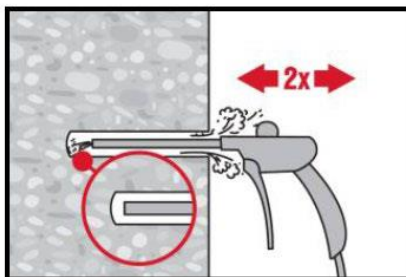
Схема очистки отверстия при помощи безмасляного компрессора
